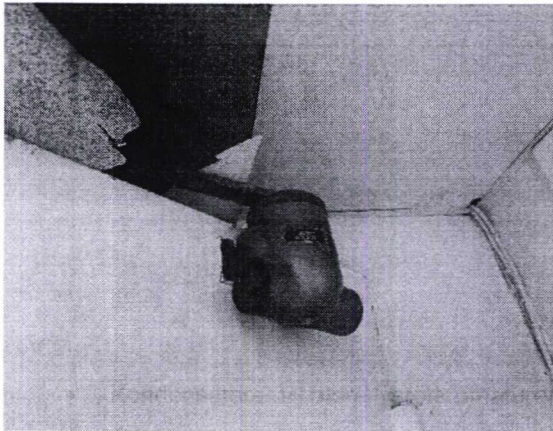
Oljefyllda dörrstängare som bedöms innehålla PCB haltig olja.
